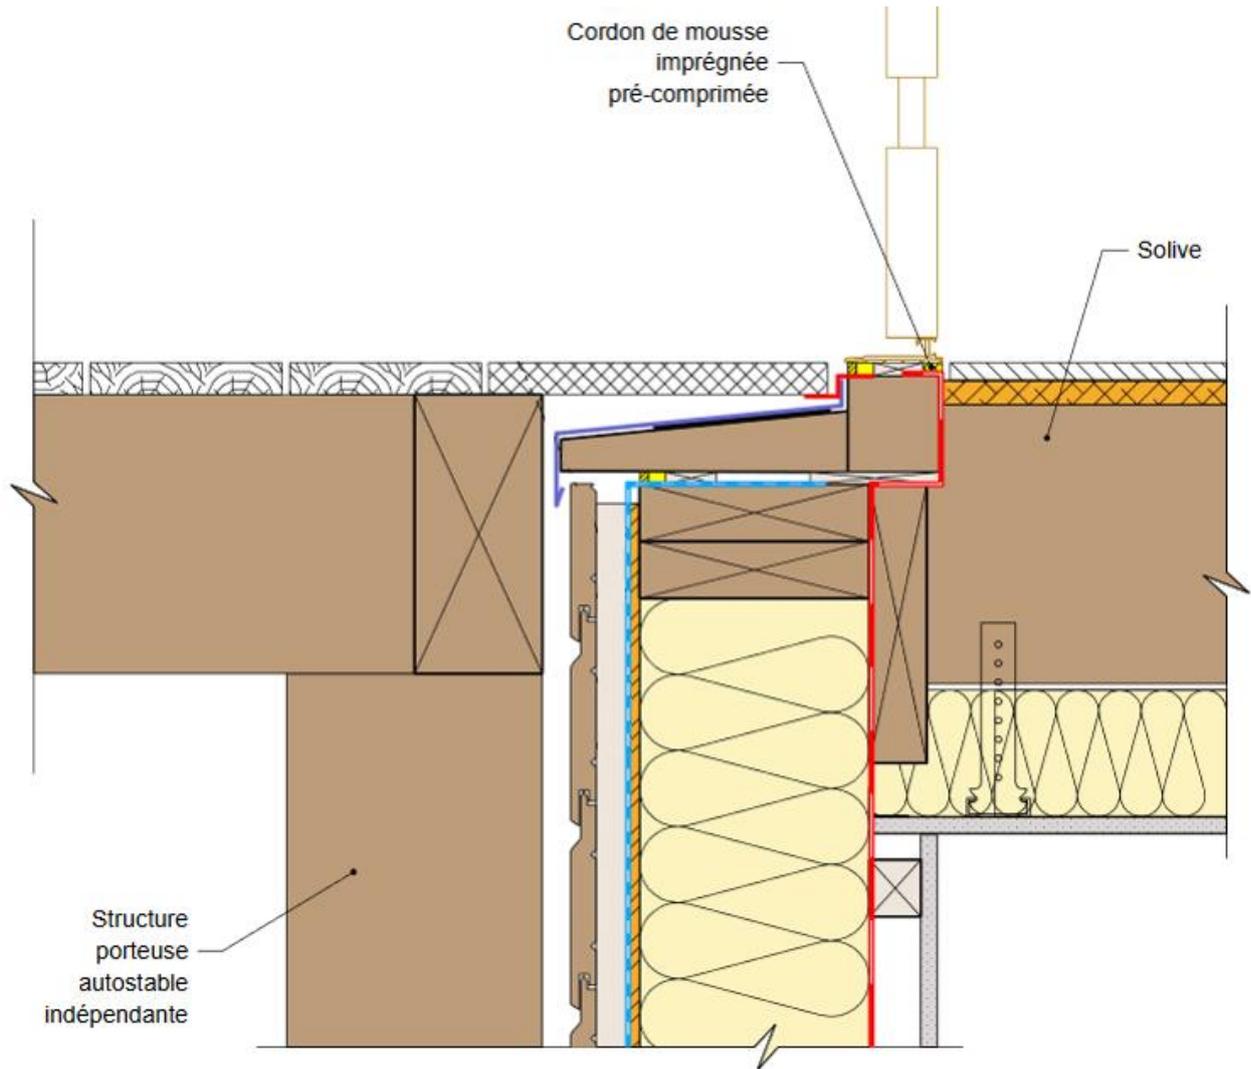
Accessibilité sur une terrasse au droit d'un plancher intermédiaire (coupe verticale)
